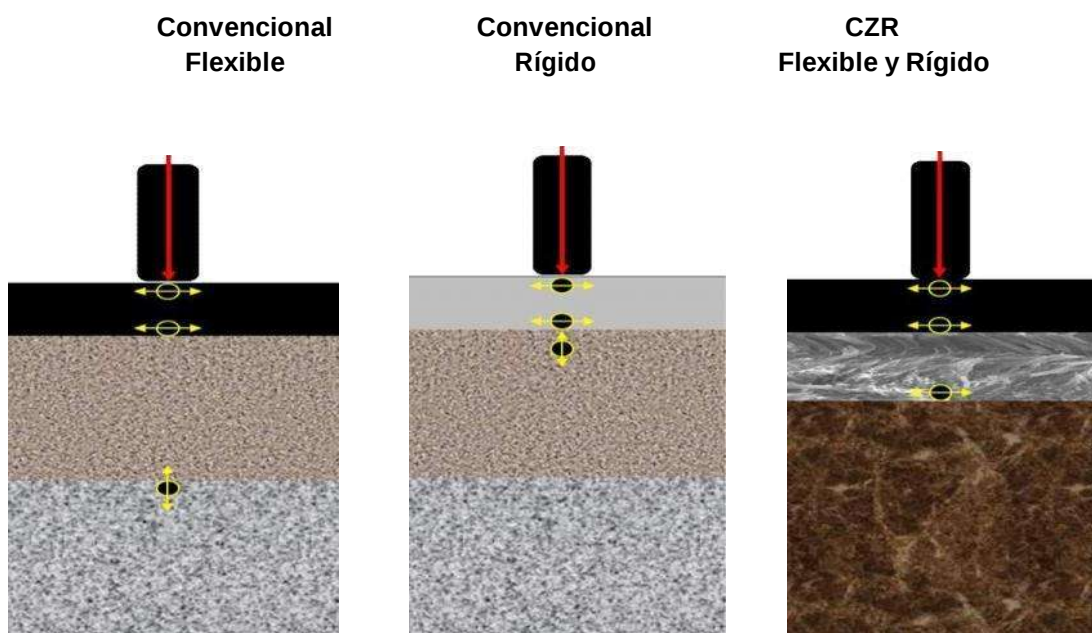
Esfuerzos y tensiones en las estructuras de Pavimentos
